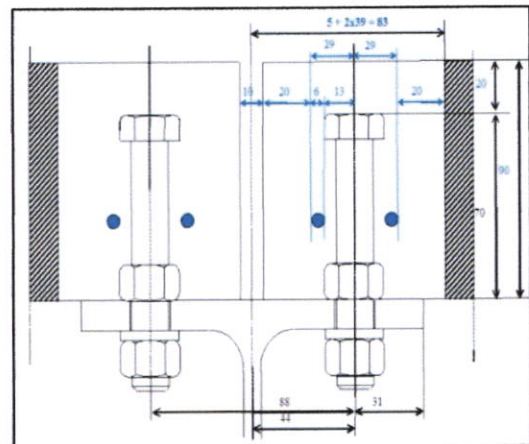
coupe sur le plancher mixte (DEMODELOR) ; source : e www.ademe.fr.
